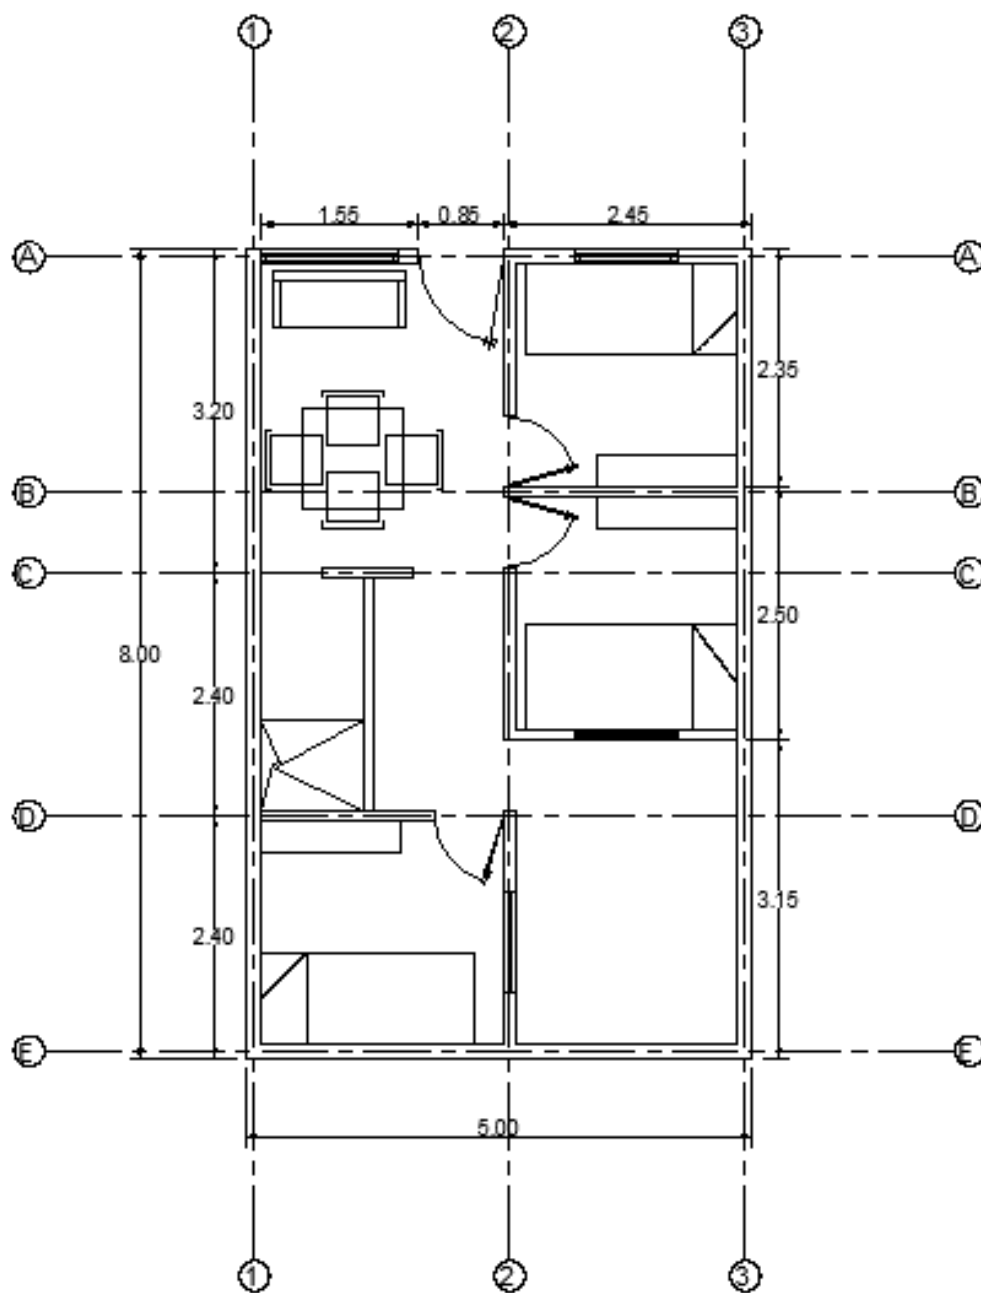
Planta general de vivienda de mampostería El Salvador
